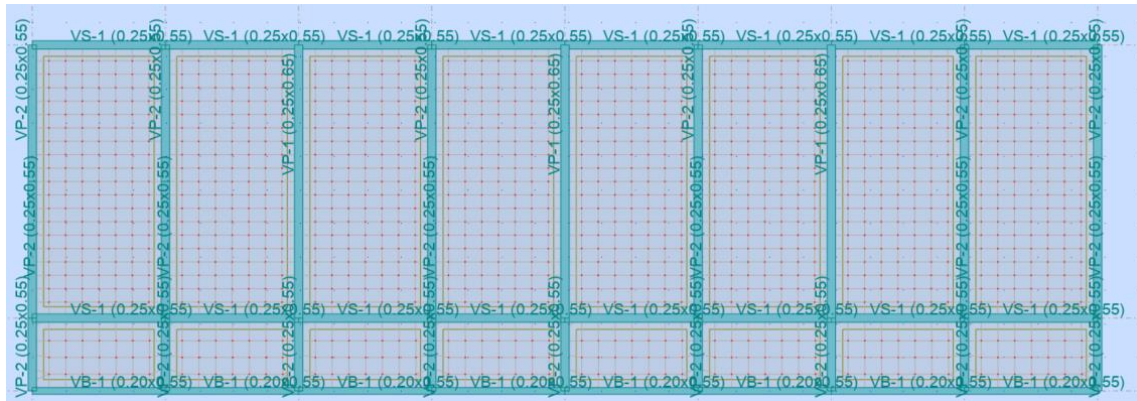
Elementos estructurales del segundo piso del Bloque B
